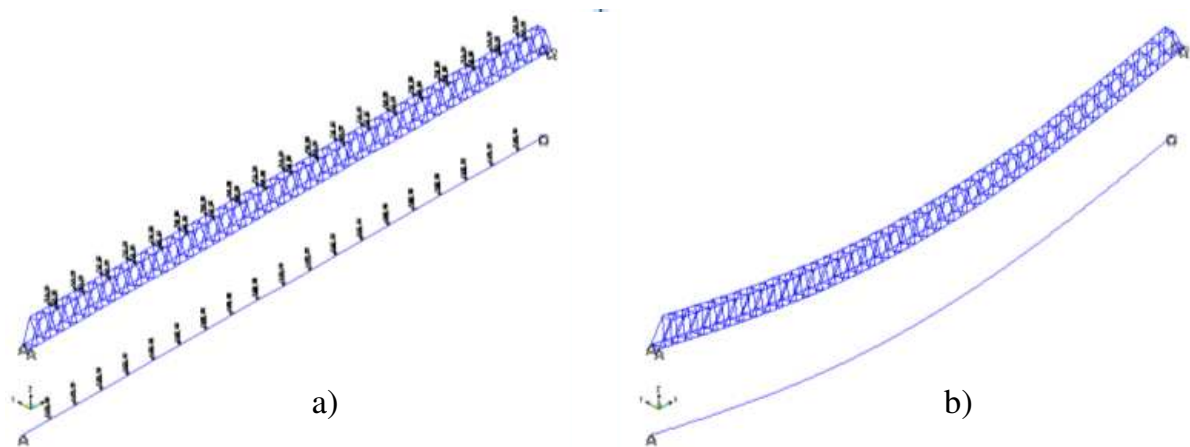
Viga reticulada. a) Modelos 3D y 1D. b) Estructura deformada.
